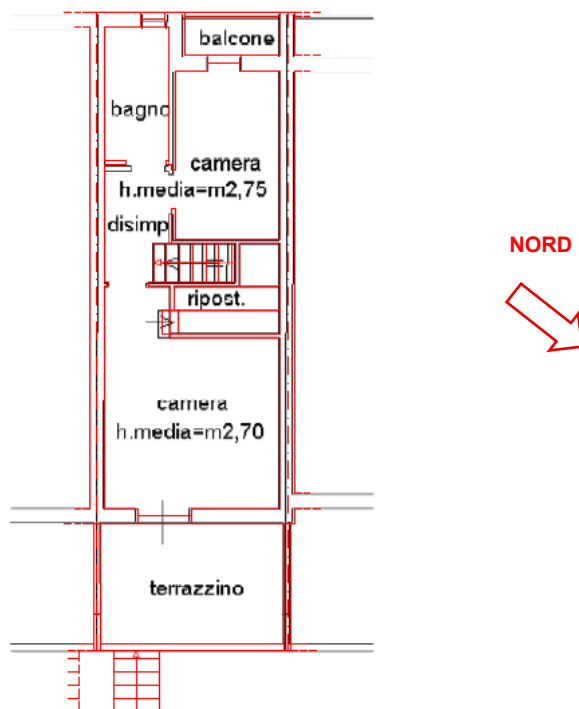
Sovrapposizione rilievo con planimetria catastale in atti (fuori scala). Piano primo
